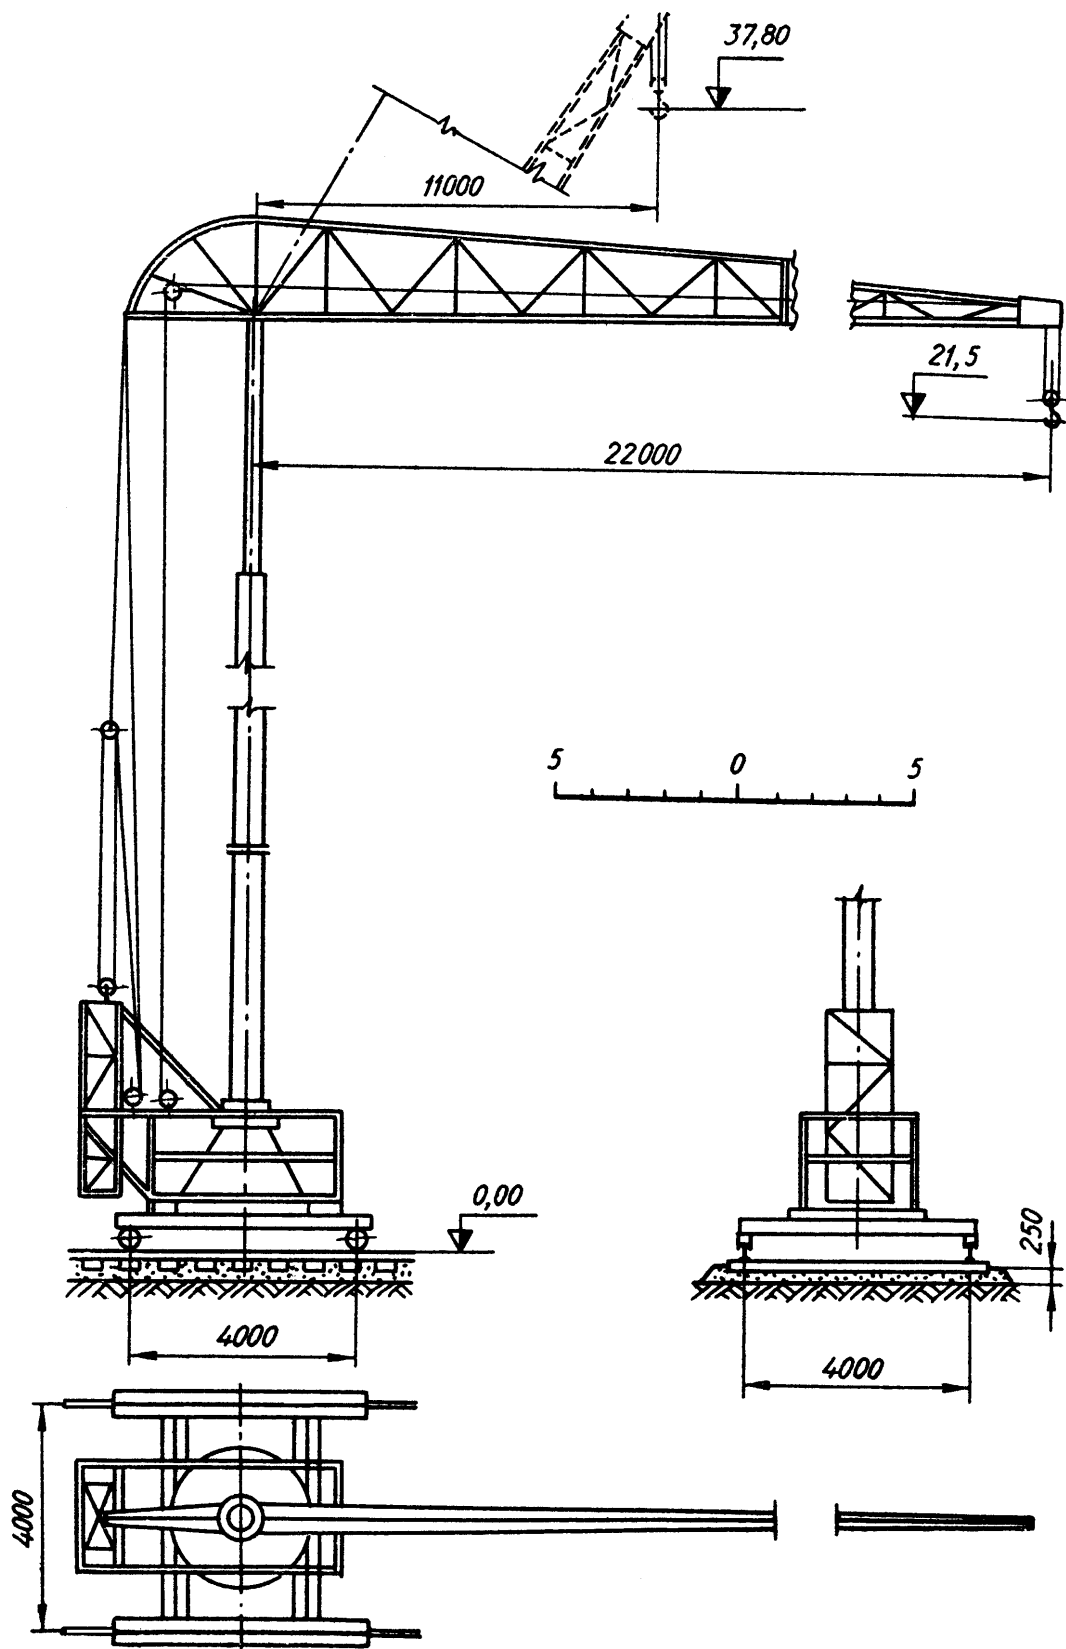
Схема трубчатого баштового крана СБК Т 2 / 22
